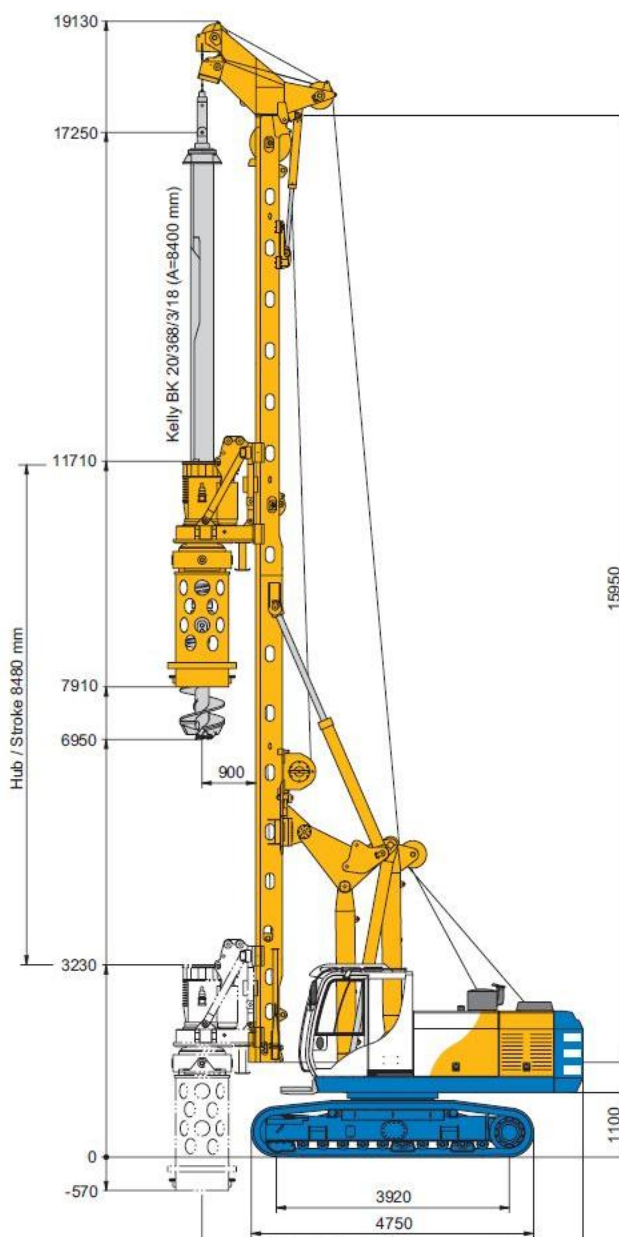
Přepravní rozměry vrtné soupravy Bauer BG 24H
